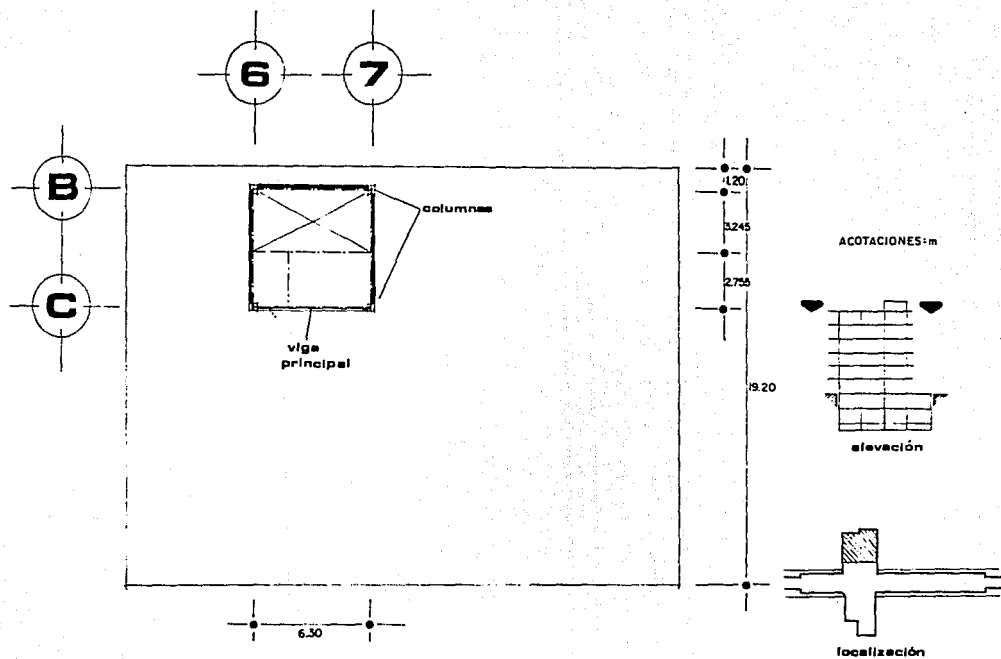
PLANTA DEL NIVEL DE CASETA
